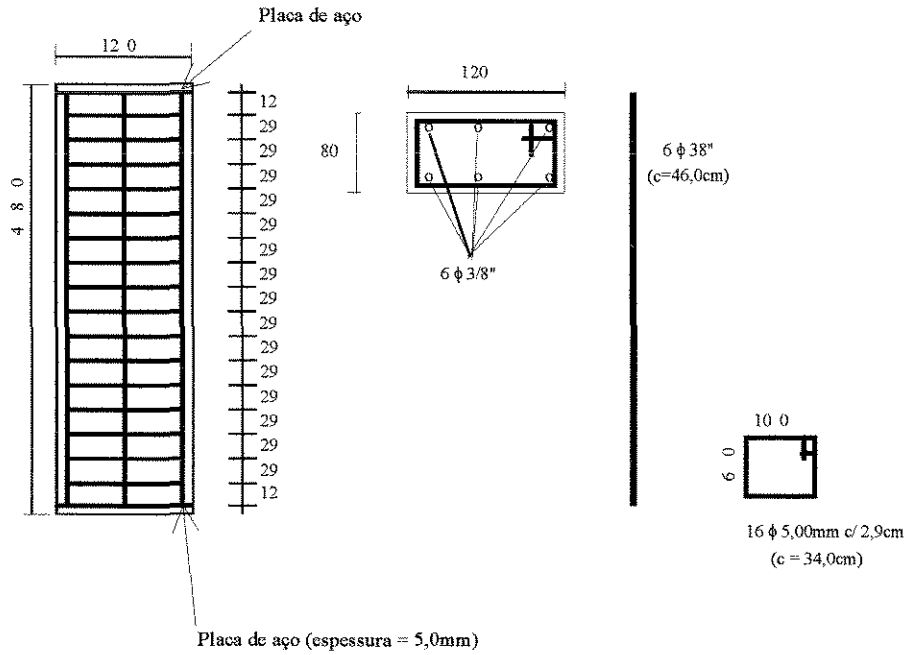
Detalhamento das armaduras dos pilares P8/12-200
